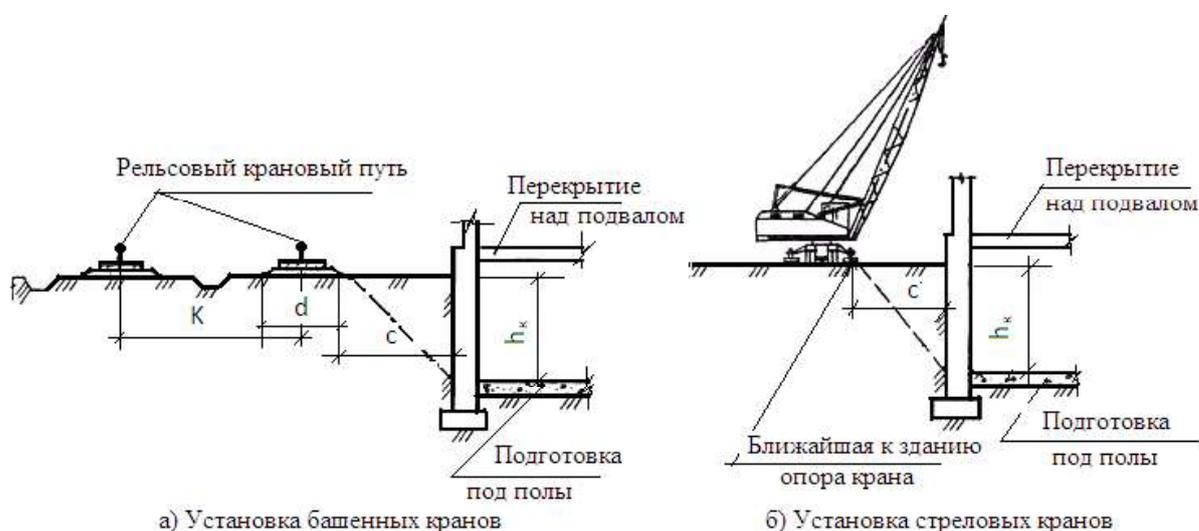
Установка башенных кранов (а) и стреловых кранов (б) у зданий с подвалом без расчета выдавливания стен от крановых нагрузок
